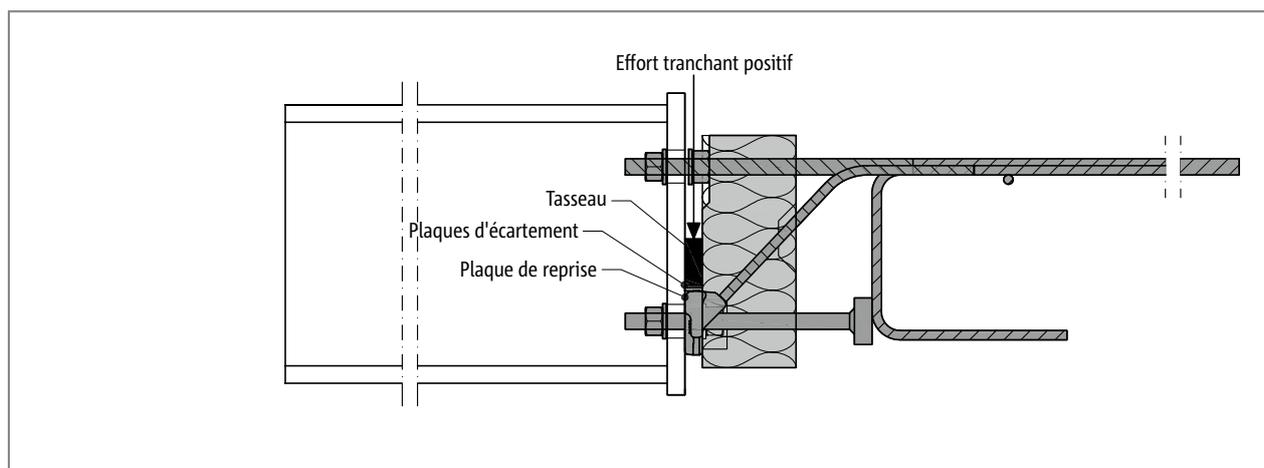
Schöck Isokorb® T type SK : taquet fourni par le maître d'ouvrage pour le transfert de la force transversale
